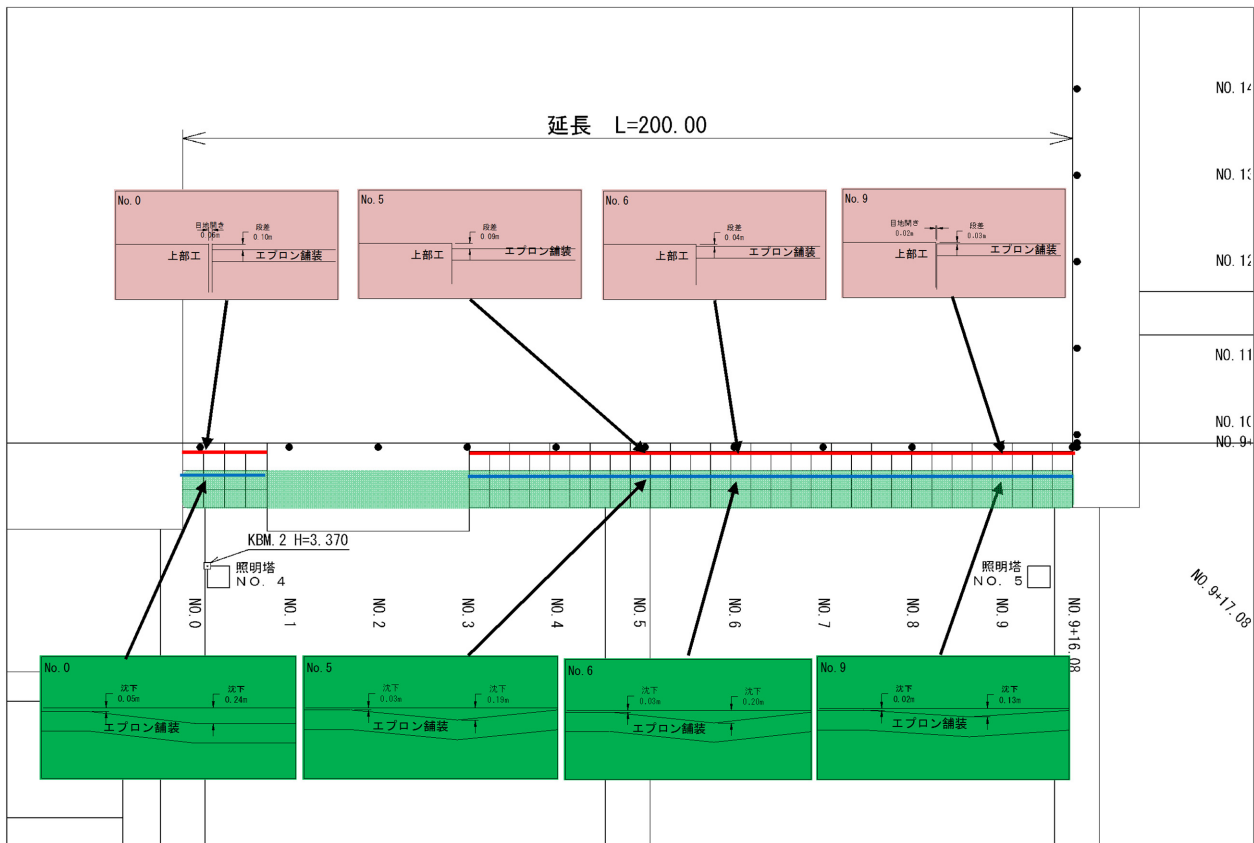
217 No.17 常陸那珂港区\_北ふ頭地区岸壁 (+5.5m) G、H の平面図 (被災後)
